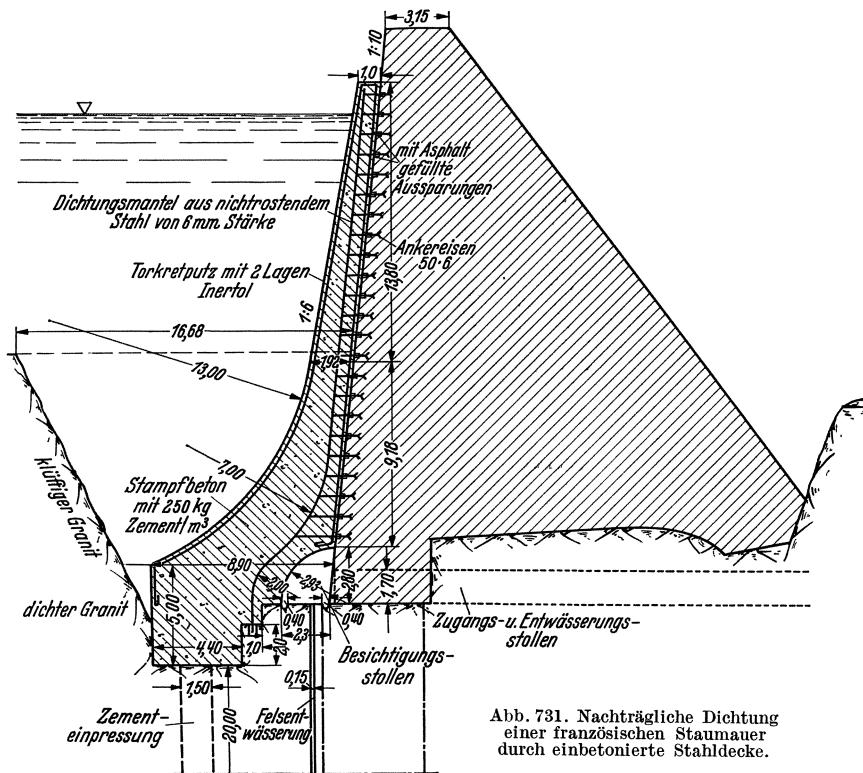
Nachträgliche Dichtung einer französischen Staumauer durch einbetonierte Stahldecke.
